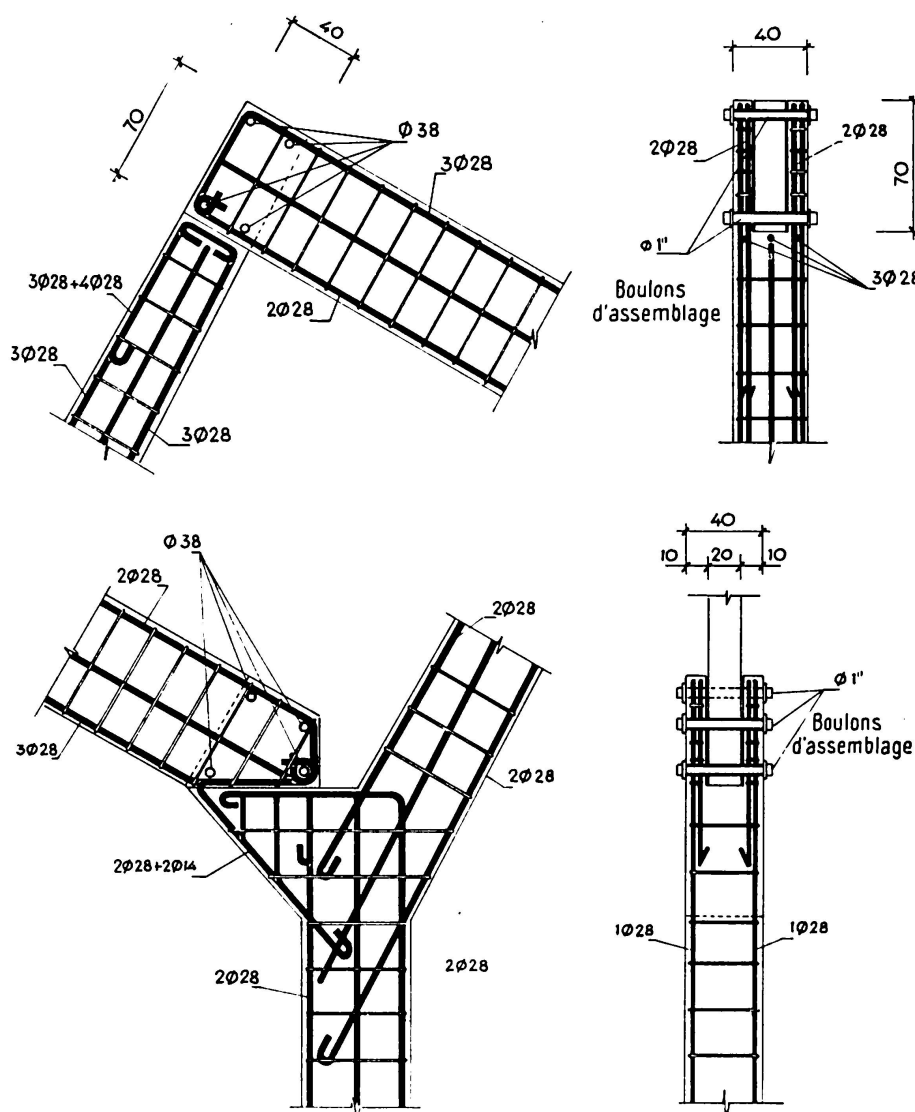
Système d'assemblage entre poutre inclinée et montant.
